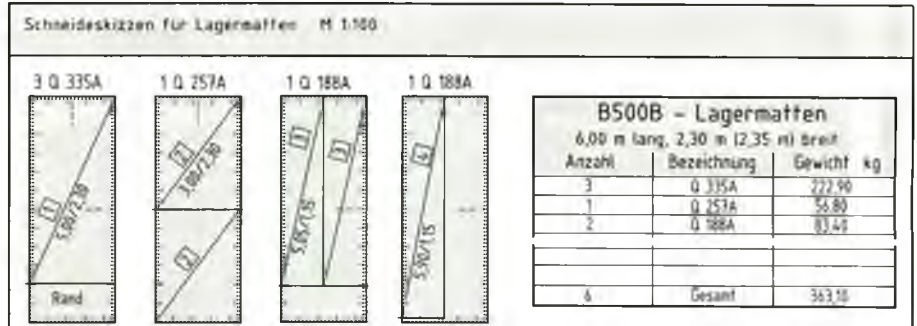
/1: Schneideskizzen und Betonstahl-Gewichtsliste
